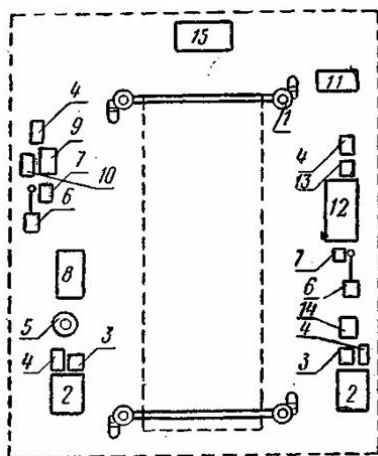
Технологическая планировка поста зоны ТО-2, оборудованного подъёмником: 1 – подъёмник; 2 – тележка для снятия и установки колёс; 3 – гайковерт для гаек колёс; 4 – ванна для промывки тормозных колодок; 5 – вращающийся стеллаж; 6 – гайковерт для гаек стремянок; 7 – воздухоподаточная автоматическая колонка; 8 – секционный шкаф; 9 – стол-тележка электрика; 10 – тележка для перевозки аккумуляторных батарей; 11 – ларь для обтирочных материалов; 12 – верстак с тисками; 13 – ящик для негодных деталей; 14 – передвижная подставка для выполнения работ сверху; 15 – канцелярский стол.
